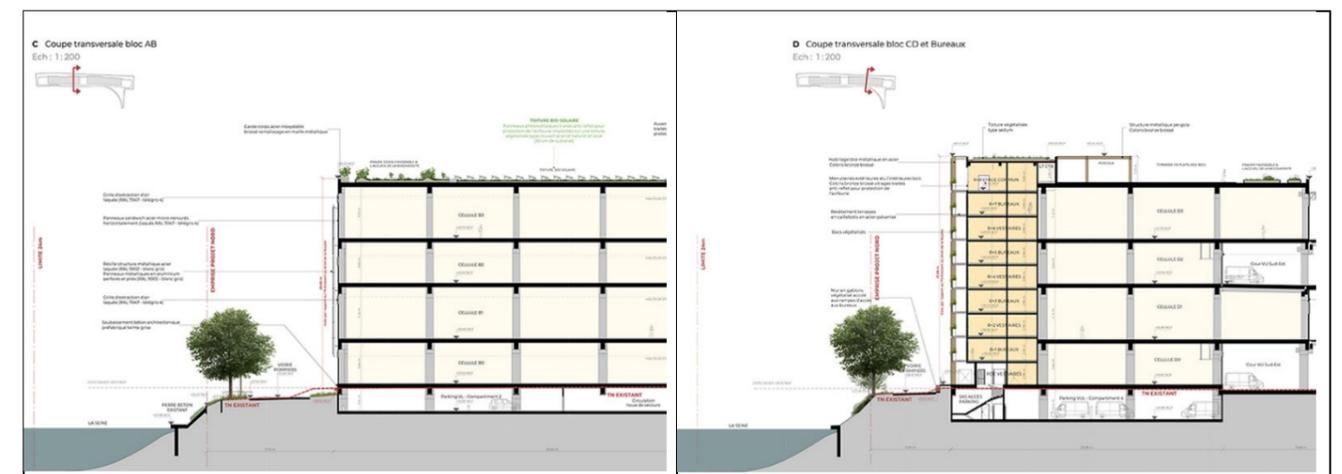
Profil sur les bâtiments, la voie pompier et les berges – documents A26 Architecture
